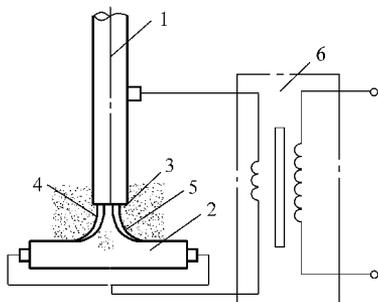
预埋件钢筋埋弧压力焊示意
